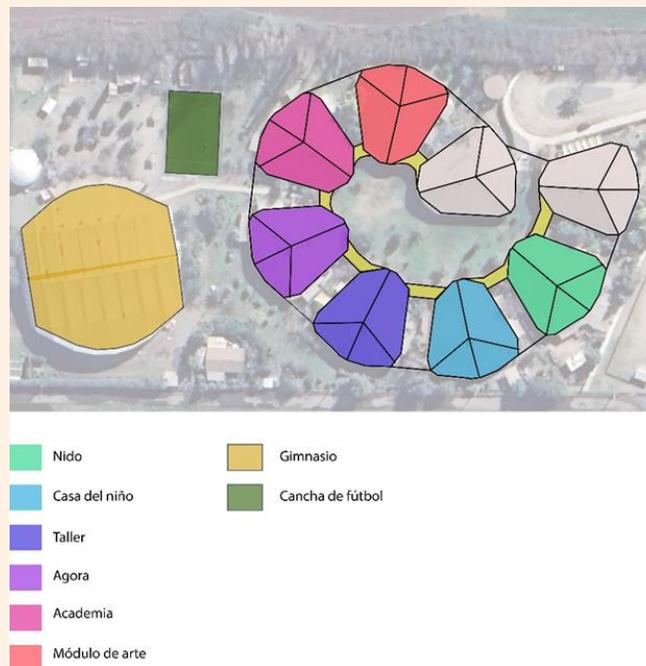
Planta arquitectónica intervenida, rescatada de Google Earth.
